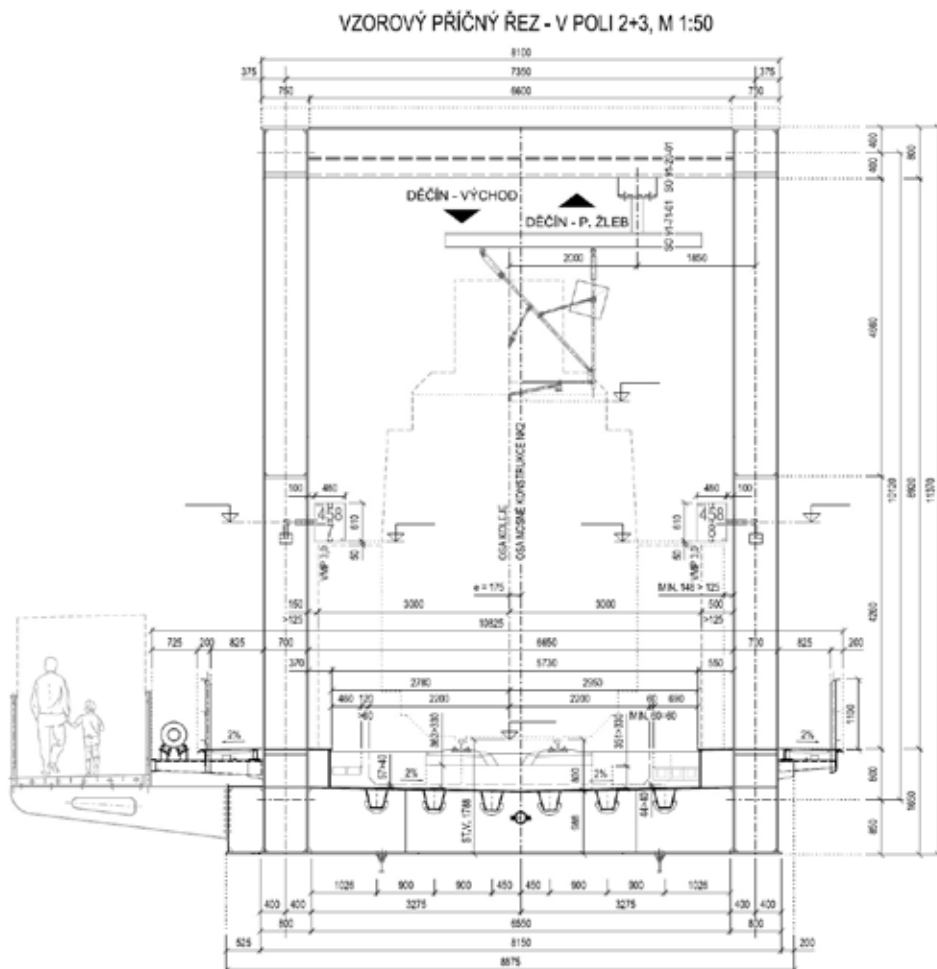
Příčný řez spráženou ocelobetonovou konstrukcí NK1
